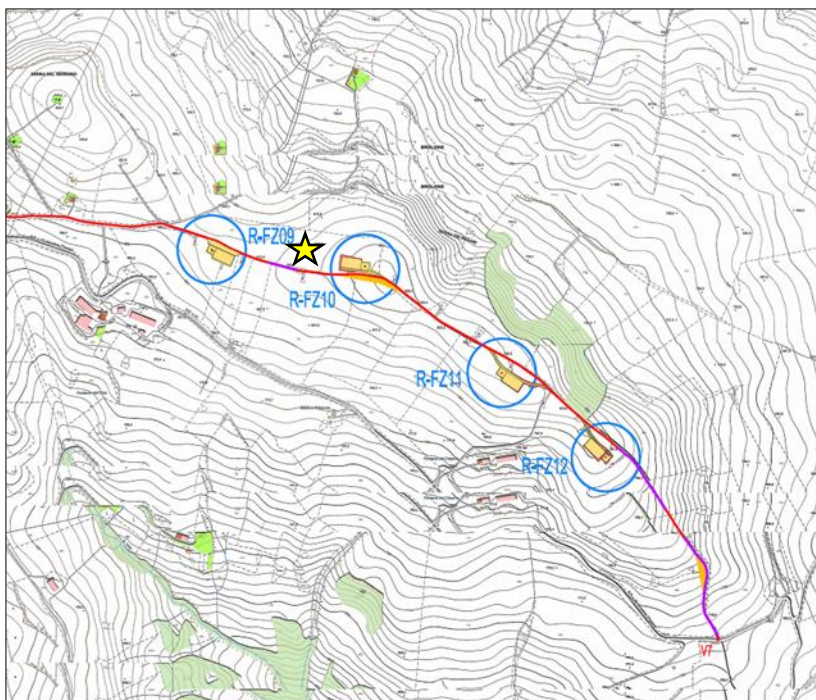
Area centro - Ubicazione area di cantiere ★
